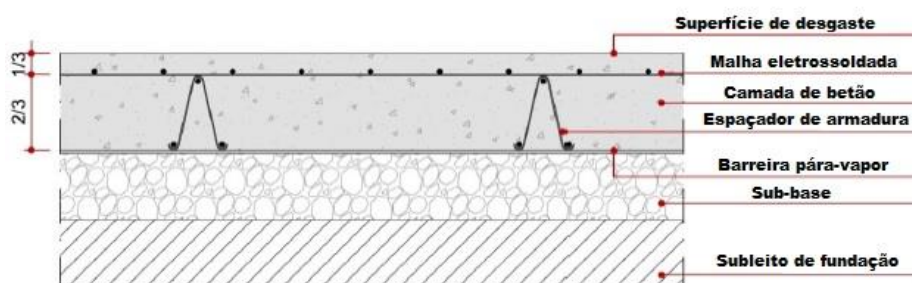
Pavimento de betão com armadura convencional/ malha eletrossoldada (malha simples) (Adaptado de [18]).
